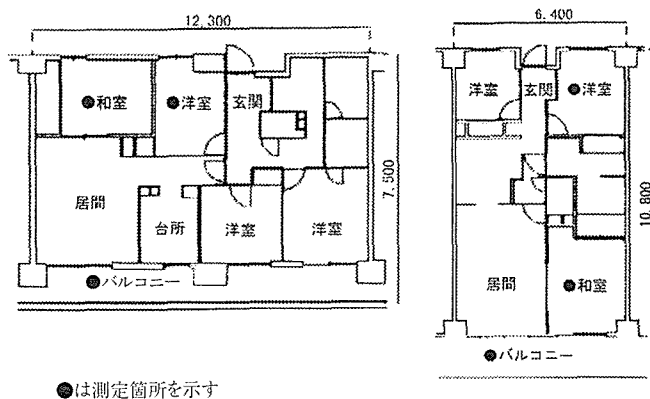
夏季測定対象平面図 図-2 冬季測定対象平面図
